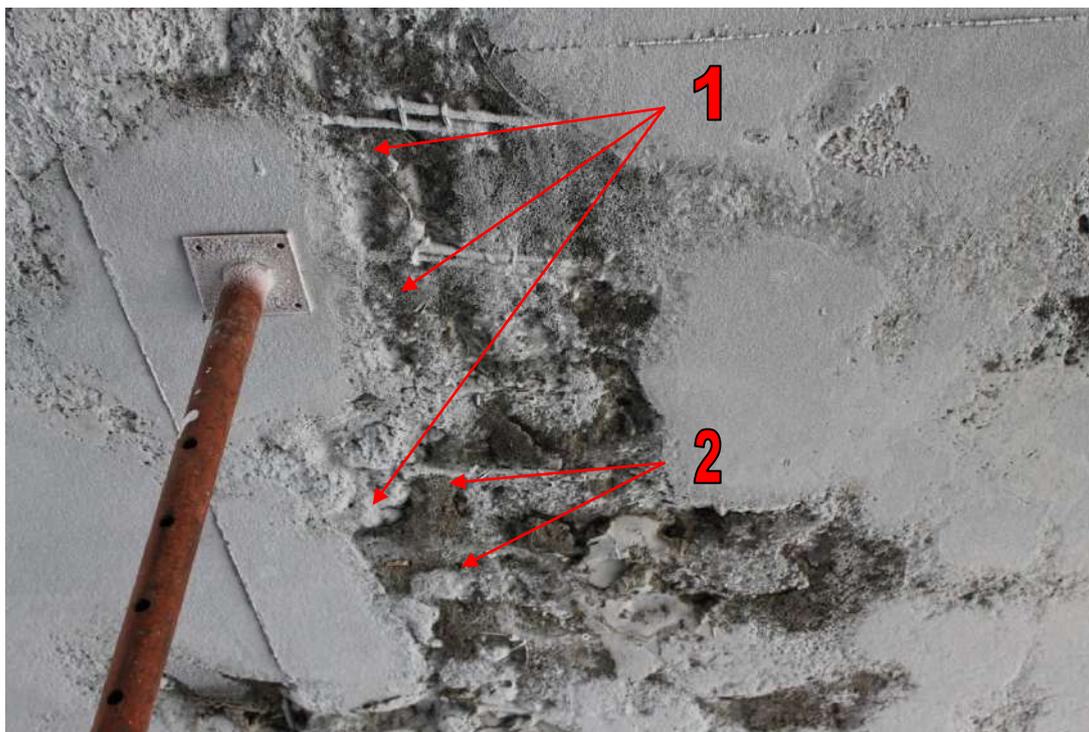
Фрагмент верхней поверхности плиты перекрытия в зоне протечек сквозь трещины: 1 – сеть усадочных трещин шириной до 1,1 мм.
